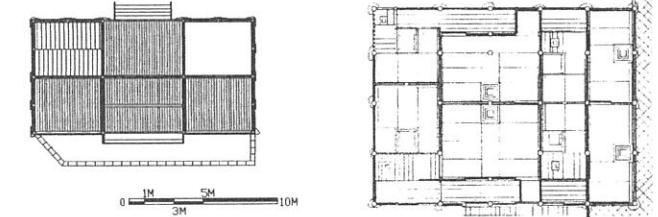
諏訪神社拝殿（左）と東大寺二月堂参籠所（右）平面図
